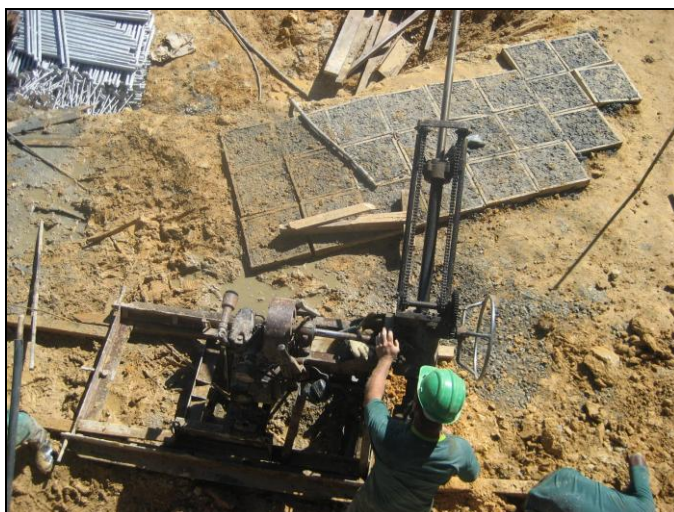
EQUIPAMENTOS QUE USAM ÓLEO LUBRIFICANTE (CONSTRUTORA 15).
